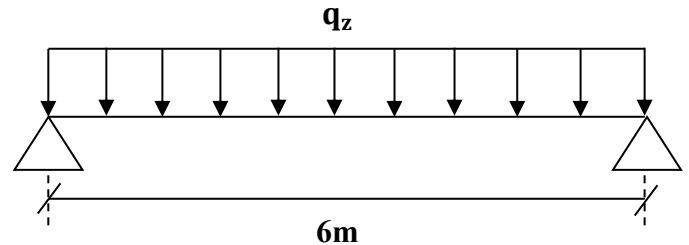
Actions sur la lisse de bardage dans le plan (Z-Z)
